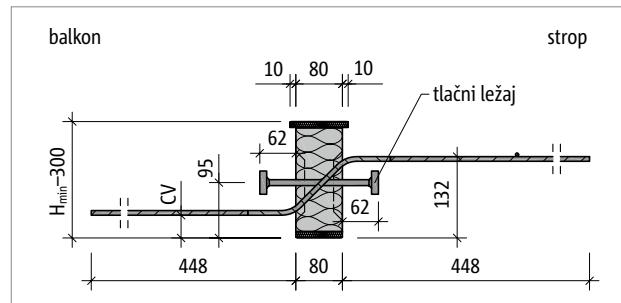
Schöck Isokorb® T tip QL-V6: tloris proizvoda
